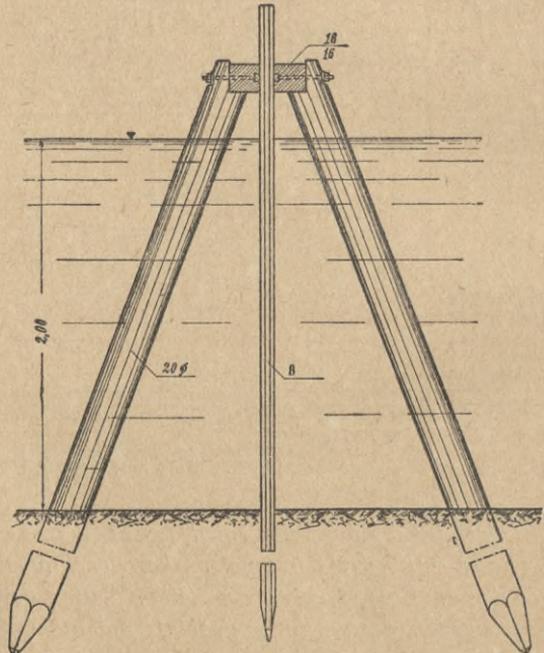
Leitpfähle zum Einrammen einer Spundwand im offenen Wasser.
